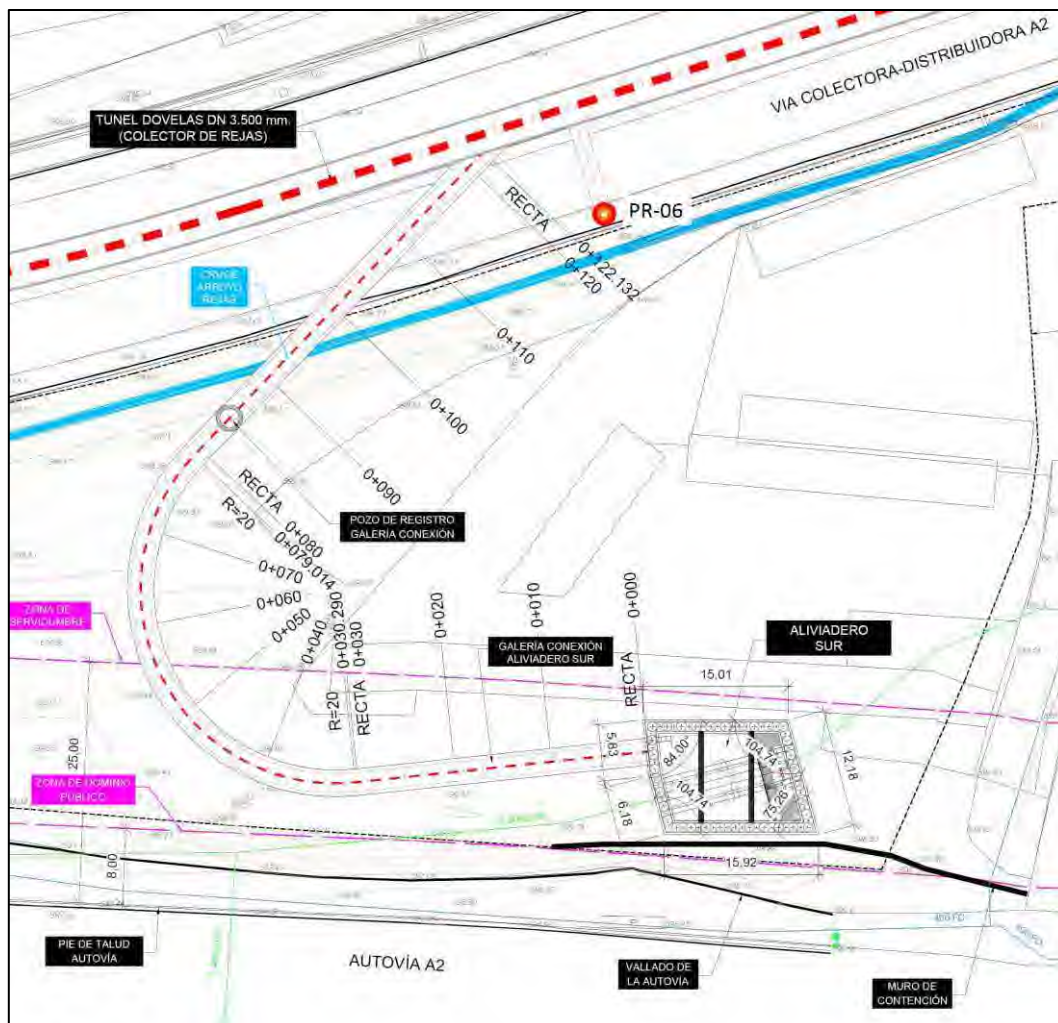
Aliviadero Sur y galería de conexión al colector de pluviales. Planta.
